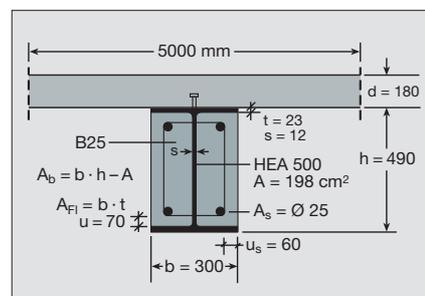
Verbundträger aus Stahlprofil HEA 500, S235; Stahlbetondecke d = 18 cm, B35; Bewehrung 4 Ø 25 BSt 500 S
